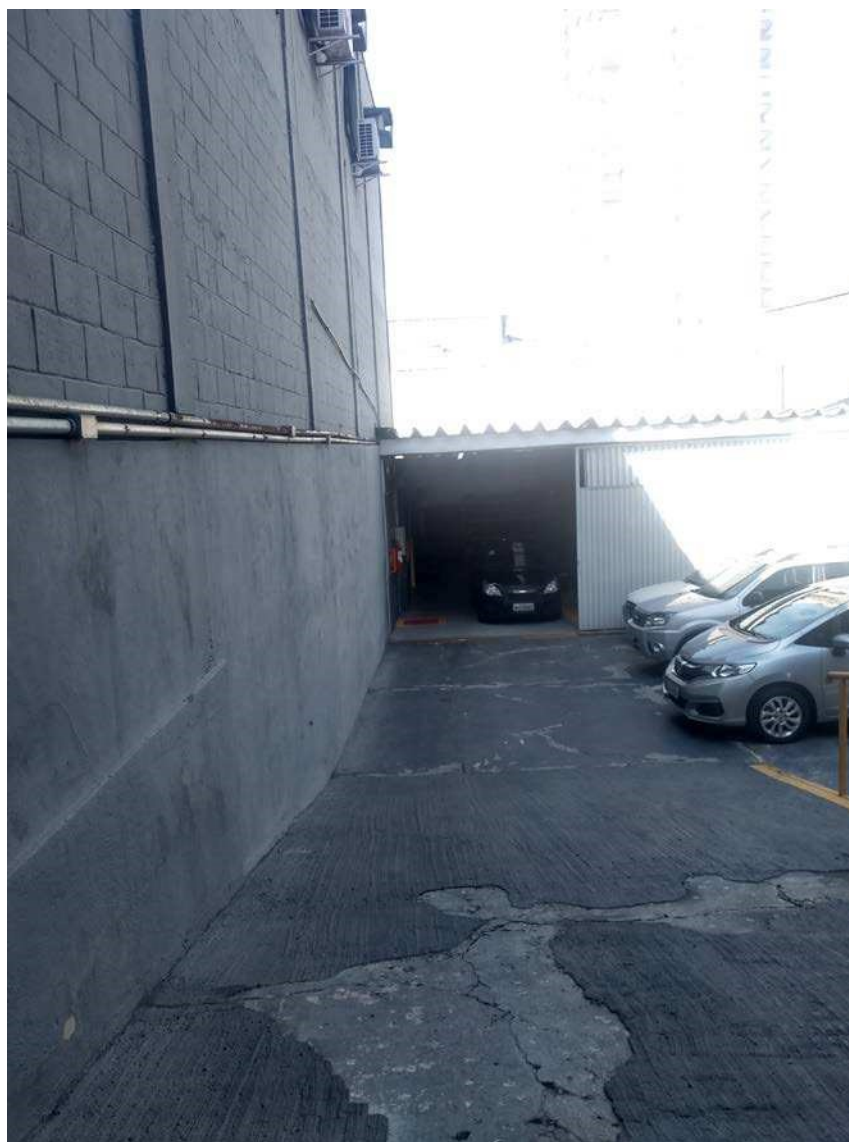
DIVISA INTERNA LATERAL ESQUERDA;
